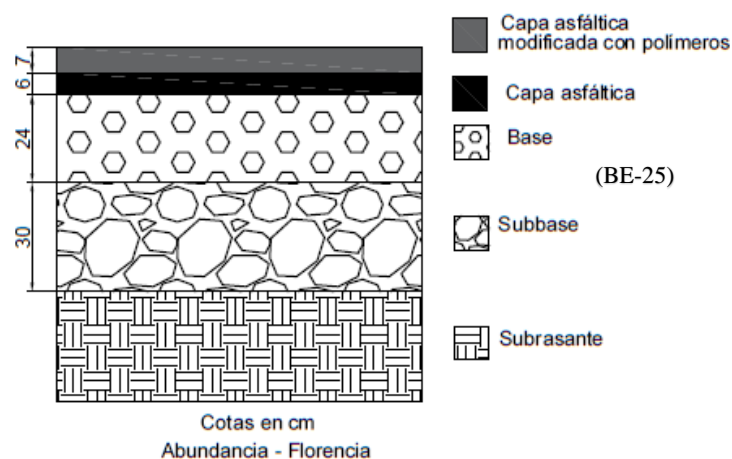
Estructura de pavimento del tramo Abundancia – Florencia
